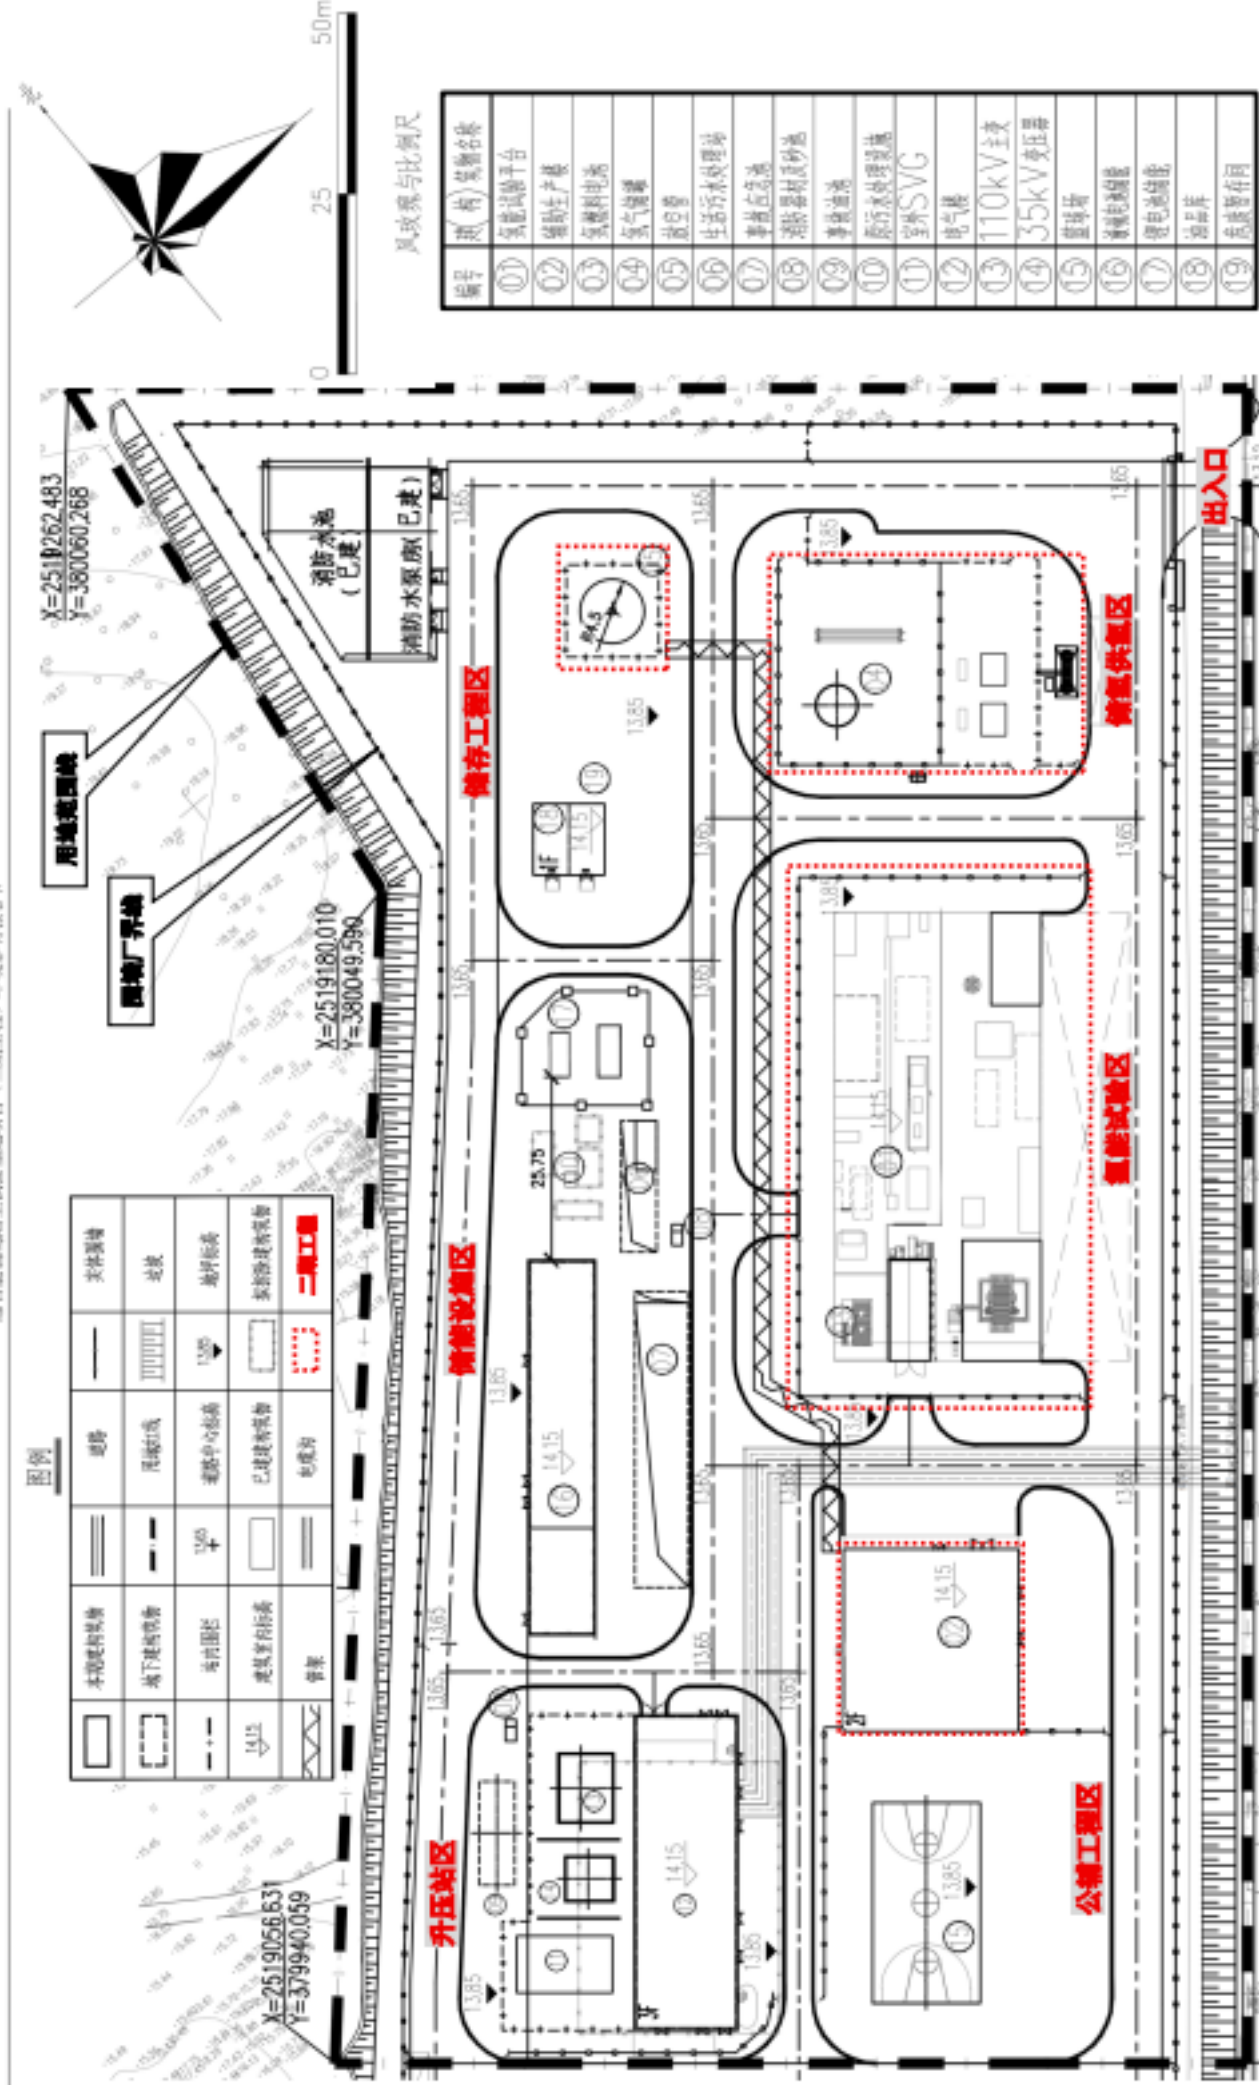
综合能源岛陆上试验基地总平面布置图
